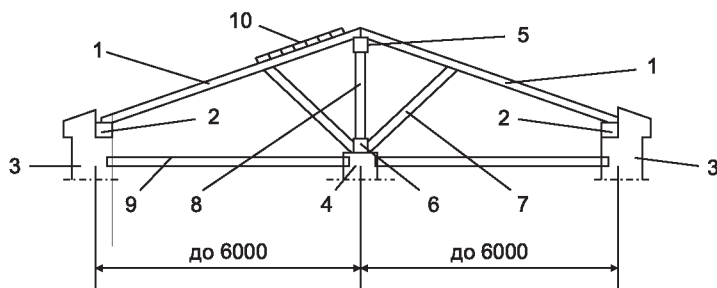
Элементы наслонного стропила: 1 — стропильная нога; 2 — мауэрлат; 3 — наружная стена; 4 — внутренняя стена; 5 — коньковый прогон; 6 — лежень; 7 — подкос; 8 — стойка; 9 — чердачное перекрытие; 10 — обрешетка
